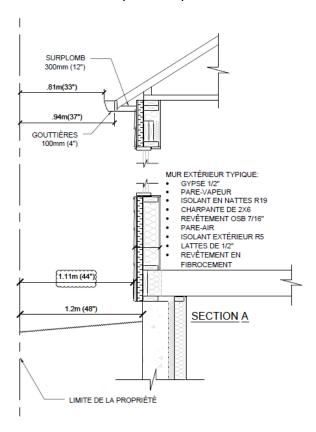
Coupe partielle du mur à un retrait de 1,2 m indiqué sur le plan d'implantation.
